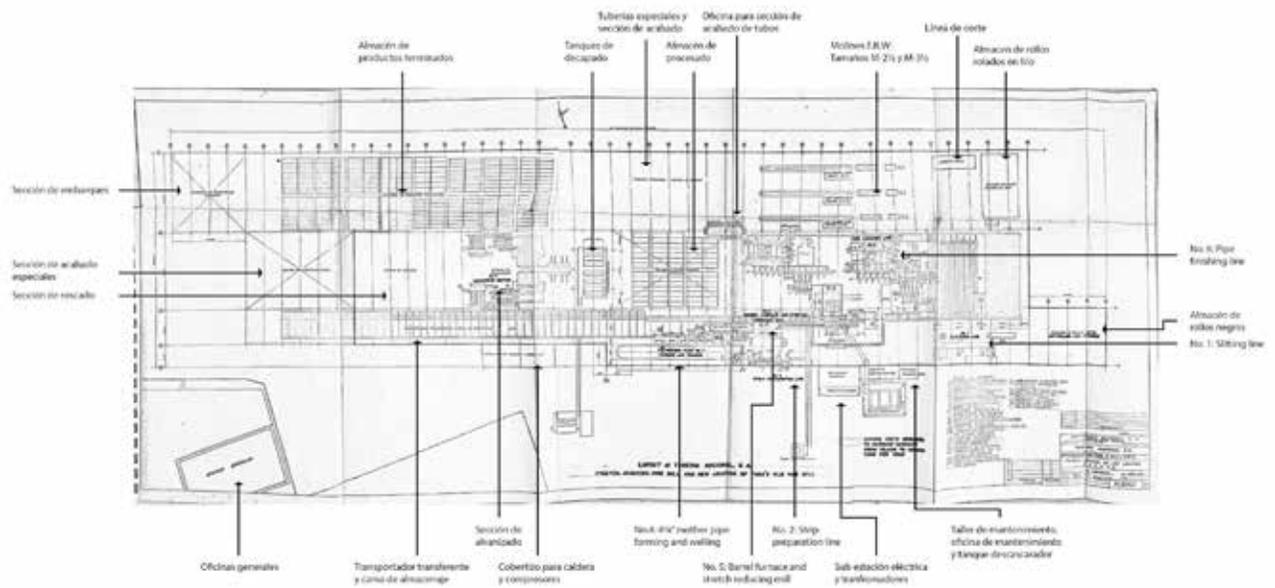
Tubería Nacional S.A., arreglo general de los equipos planta. Plano realizado por Edificaciones Monterrey. AHF, Empresas Filiales, Sección TUNA, Caja 10, Exp. 216.
